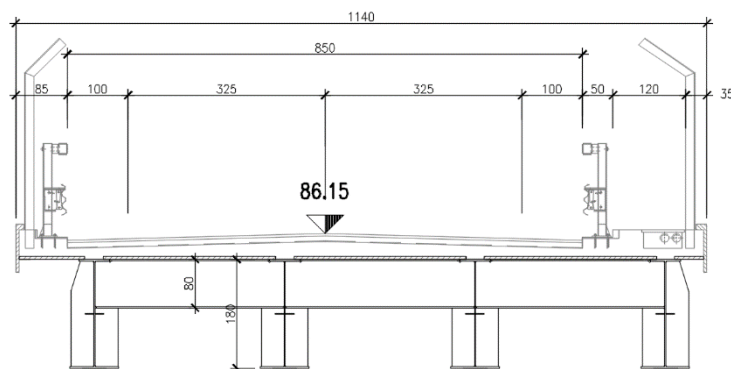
IV03 Cavalcavia Via Fenilon - Sezione trasversale Campate 1 e 2
